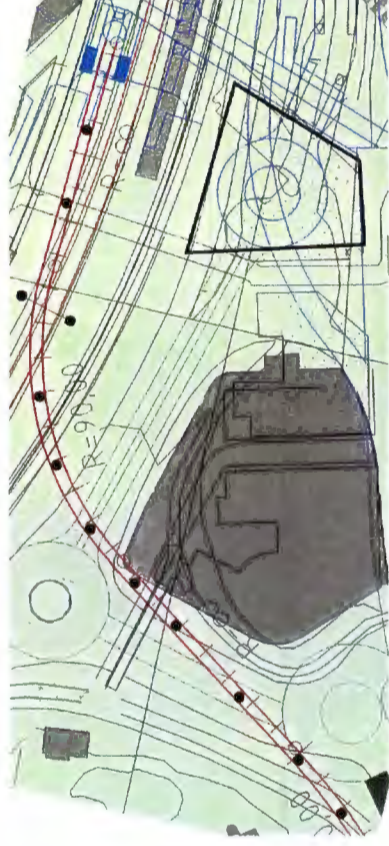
Cable Car-systemet ender i en butt over jernbanestasjonen.
